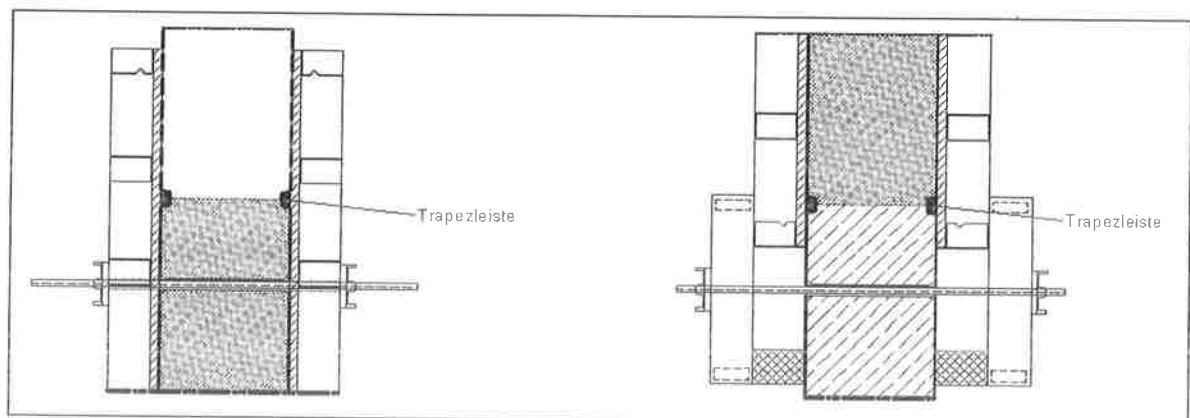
Arbeitsfuge mit Trapezleiste; links: erster Betonierabschnitt; rechts: zweiter Betonierabschnitt
